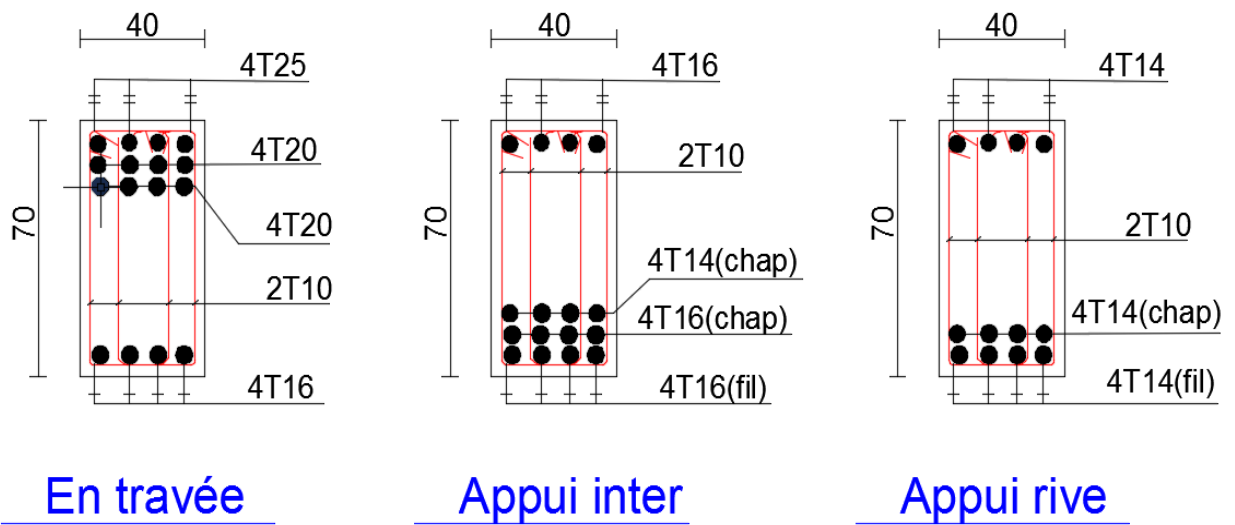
Ferrailage de la poutre de libage suivant le sens longitudinal.
